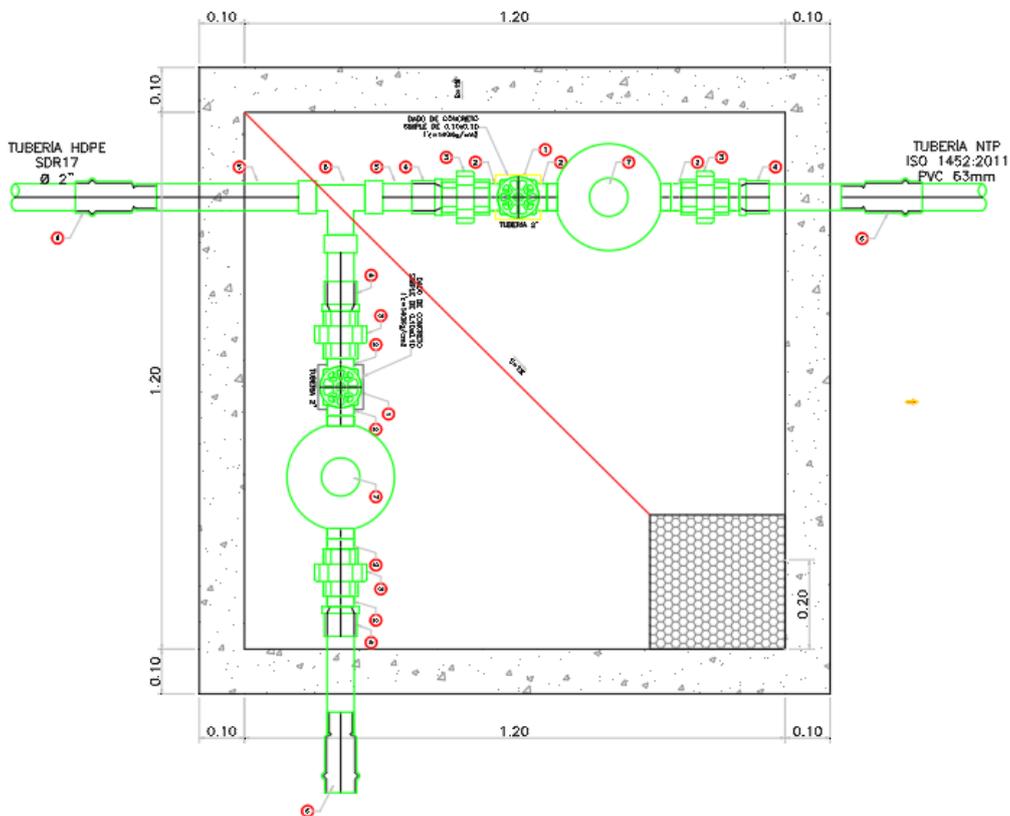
Planta caja de Válvulas Distribuidora de Caudal
